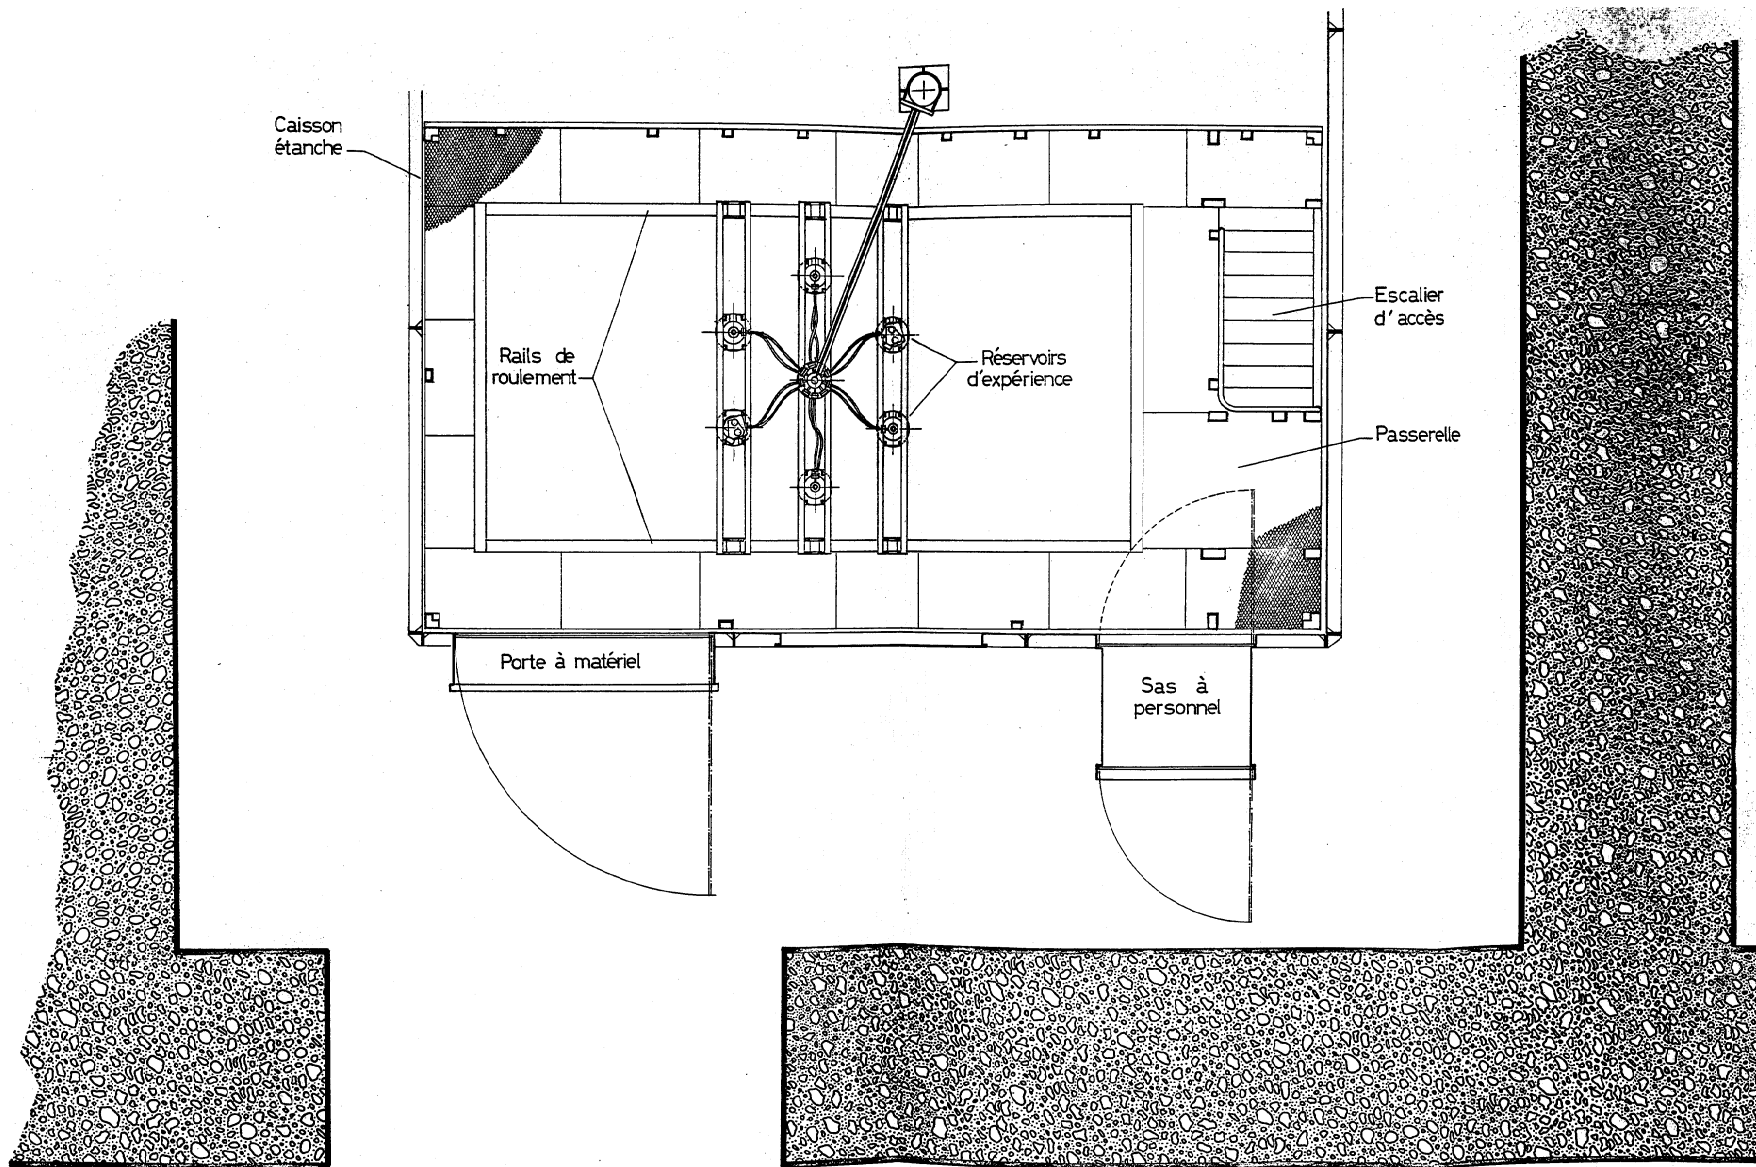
APPAREILLAGE B - VUE EN PLAN
